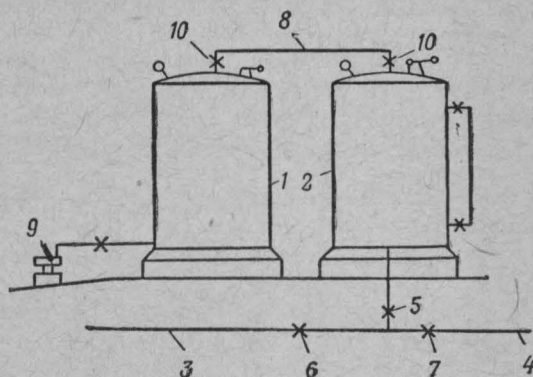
Схема устройства пневматической установки с переменным давлением:
